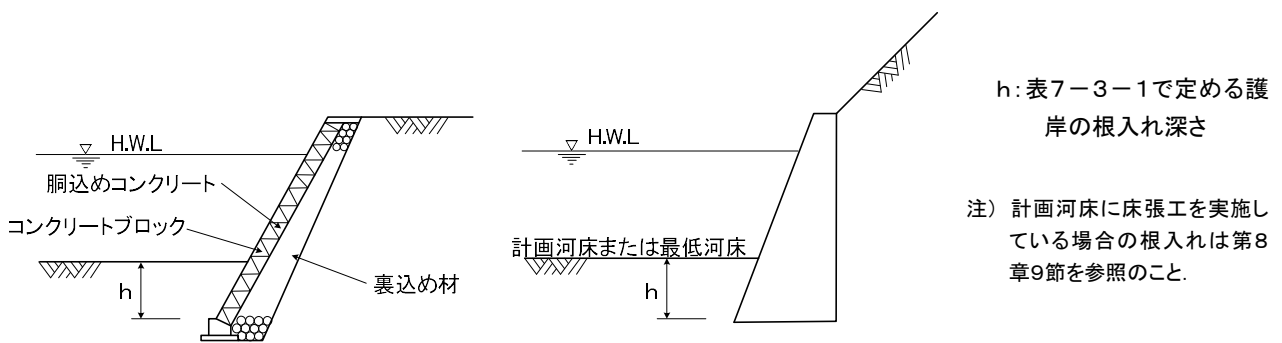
護岸の根入れ(砂礫地盤の場合)
